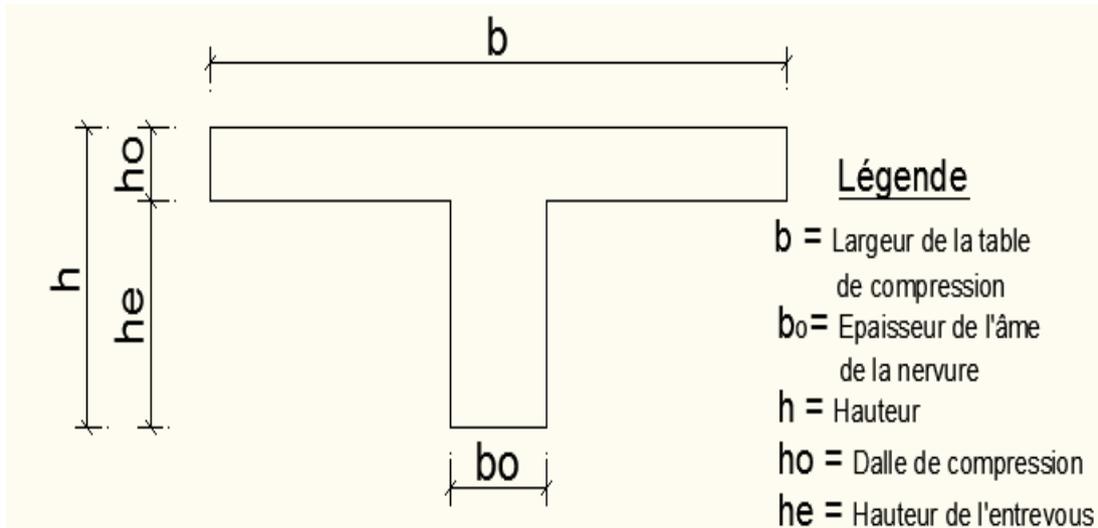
Coupe partielle sur la dalle (source Salomon CHABI)
